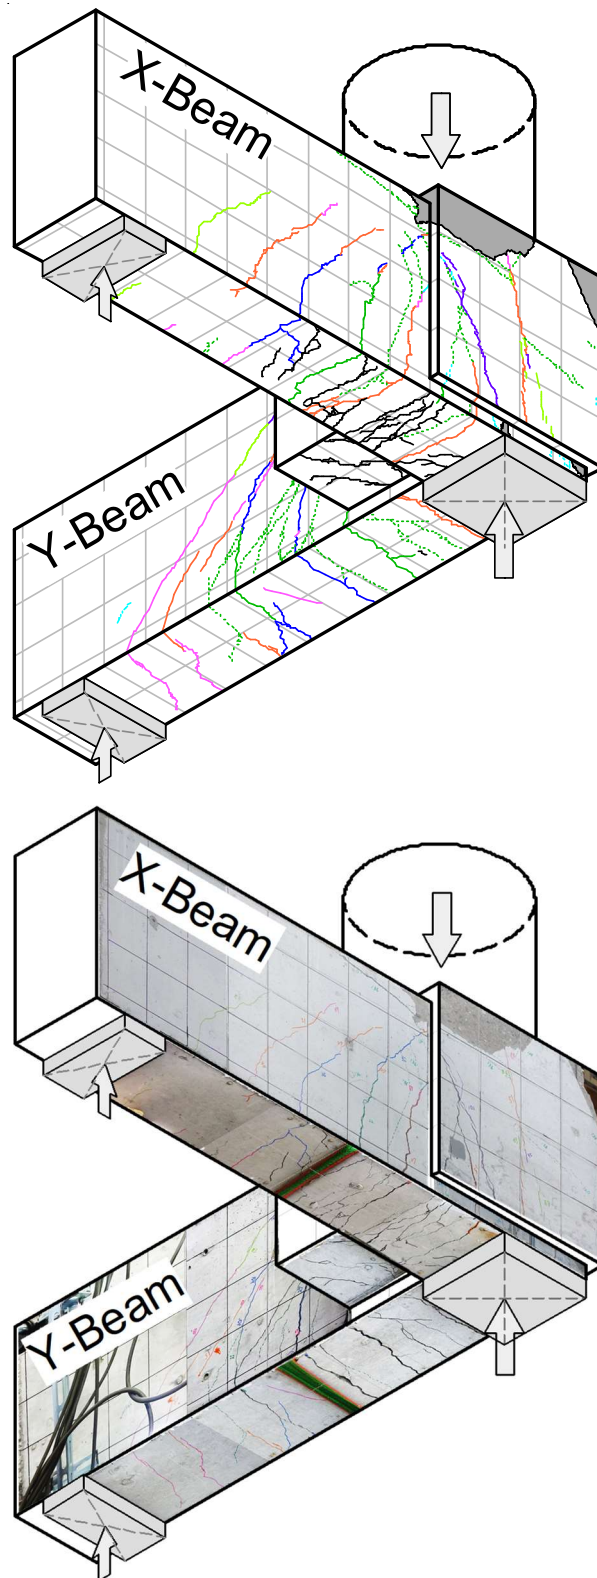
試験体 PCB 最終損傷状況一視点①
